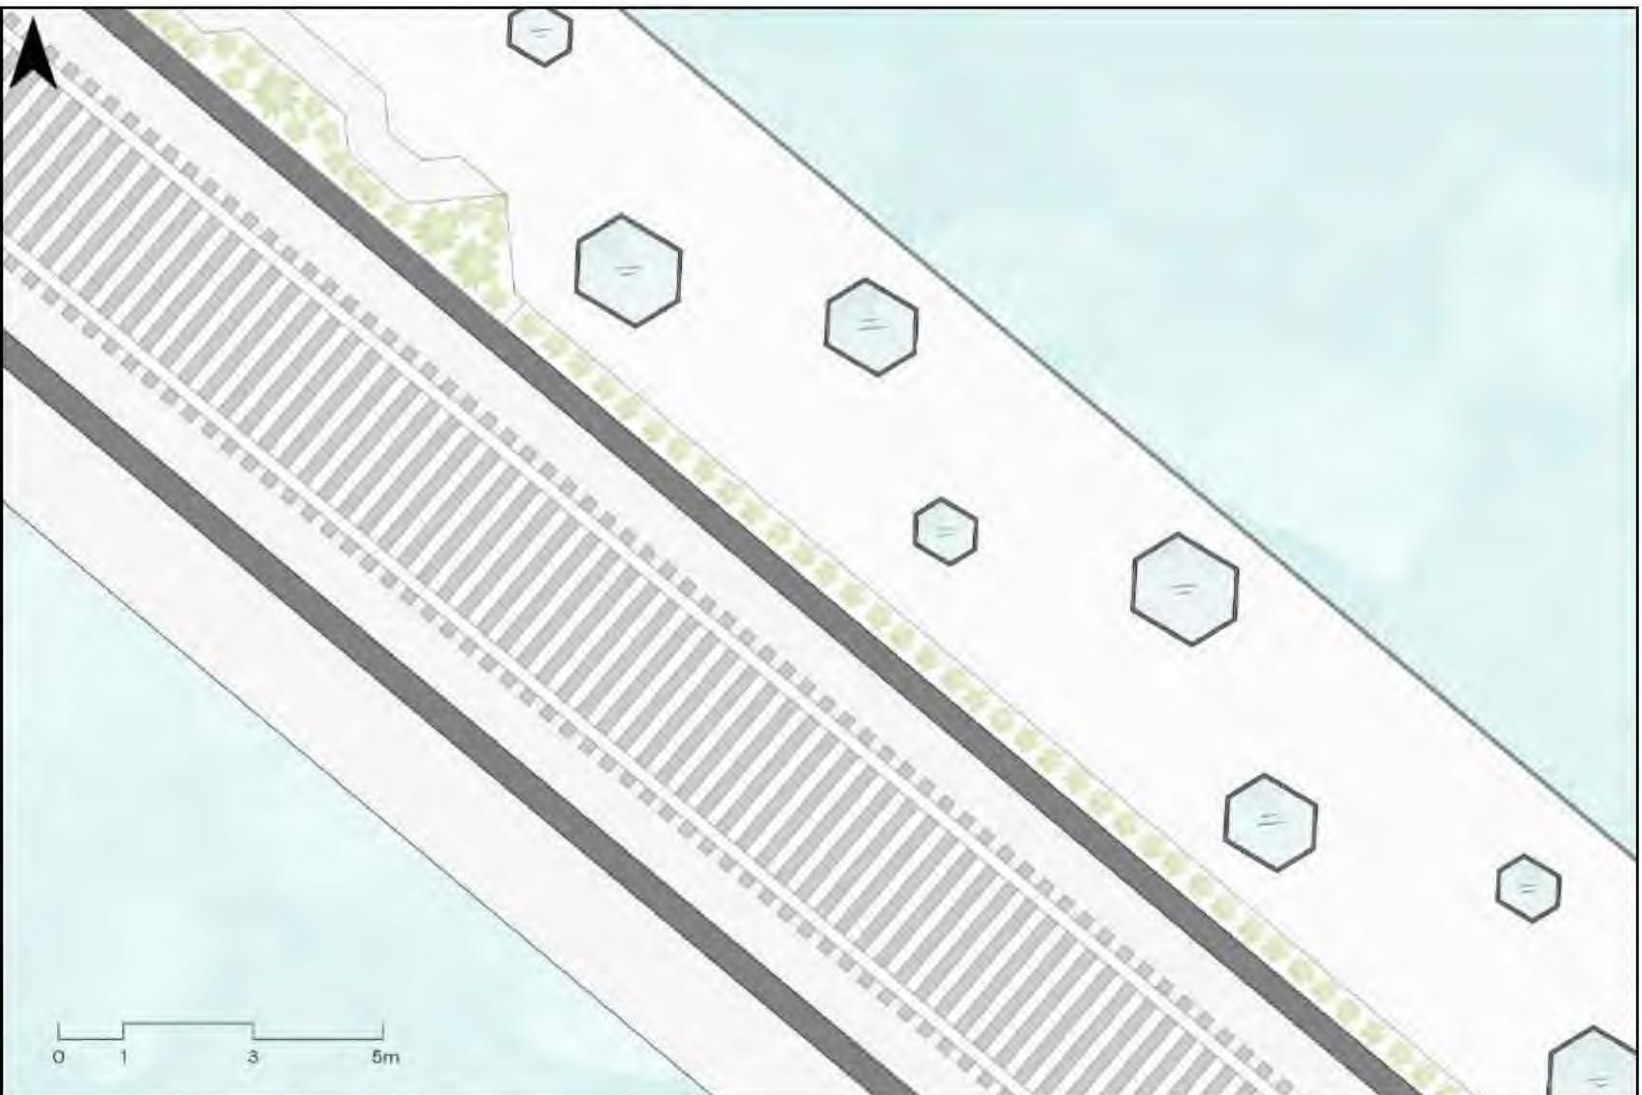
Planta arquitectónica del paseo peatonal en el tramo reconstruido del puente. Fuente: Autoría propia.
